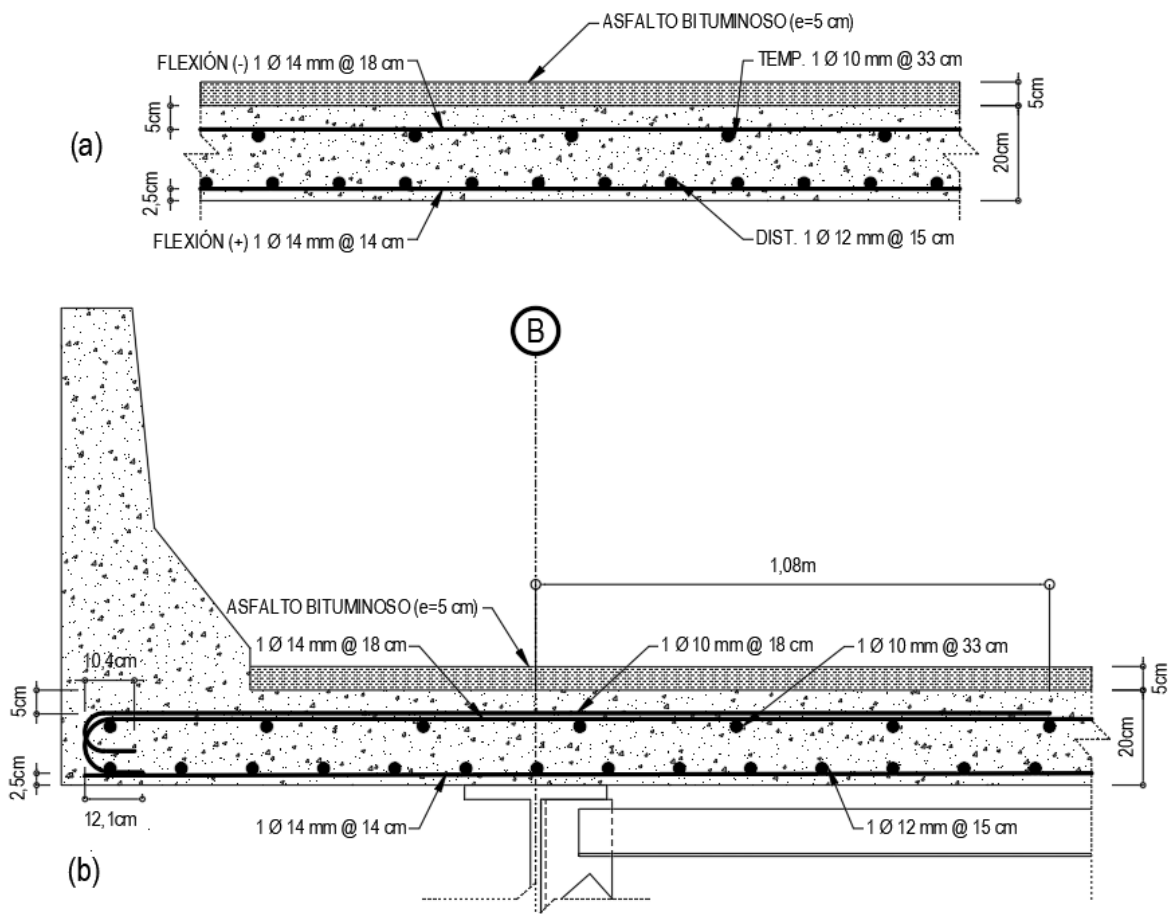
(a) Sección transversal de la losa y (b) volado de losa
